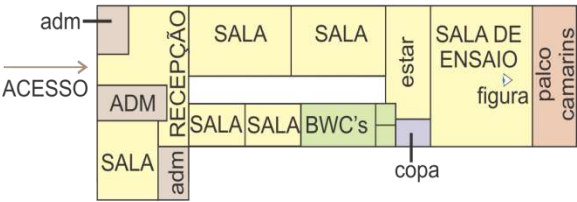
Croqui da planta da Cenarium / edificação térrea
